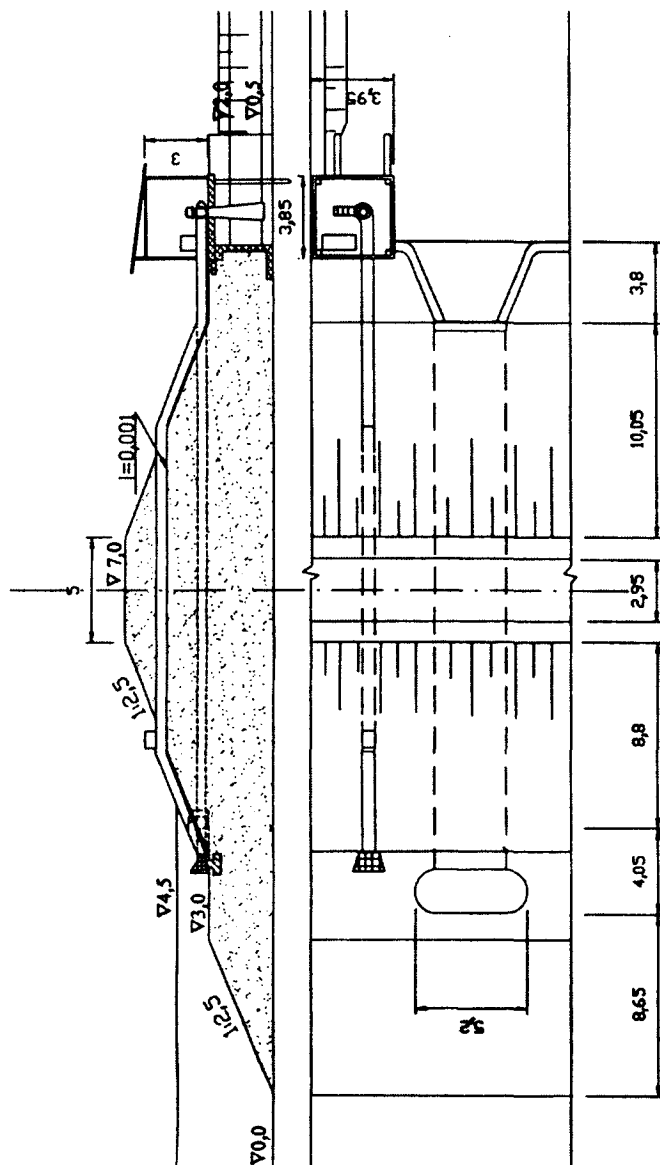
Здание микроГЭС с напорным трубопроводом
